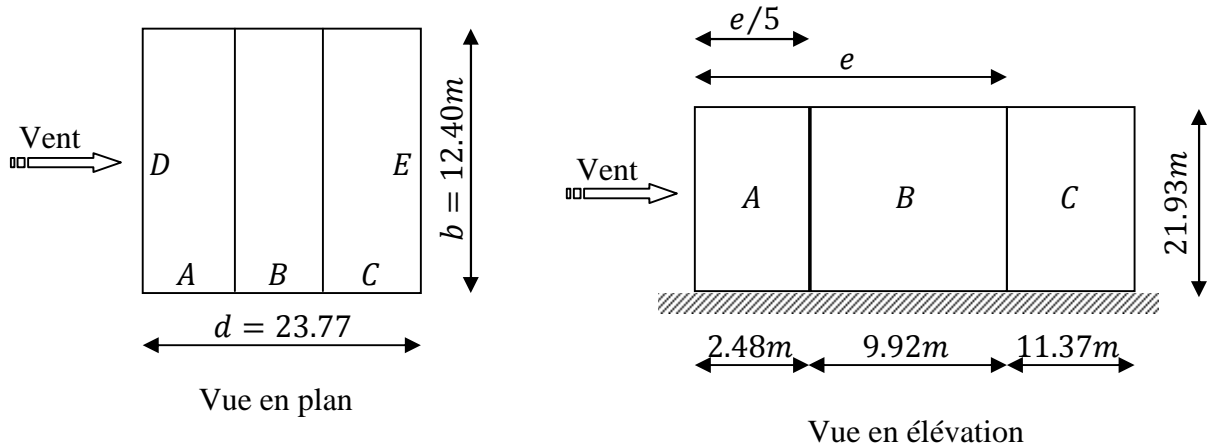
vue en plan et en élévation des zones de pression sens V2
